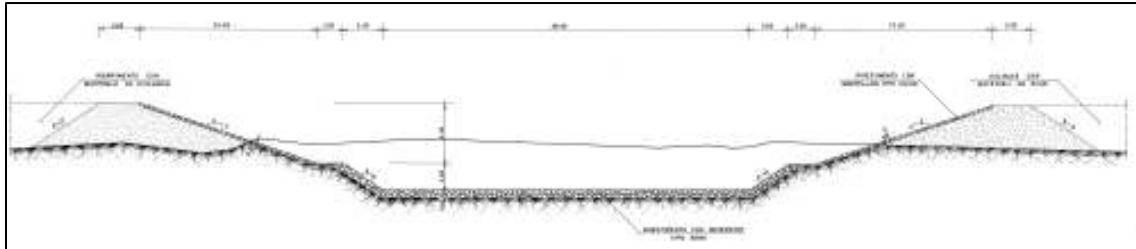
Canale di restituzione in alveo – Sezione trasversale
